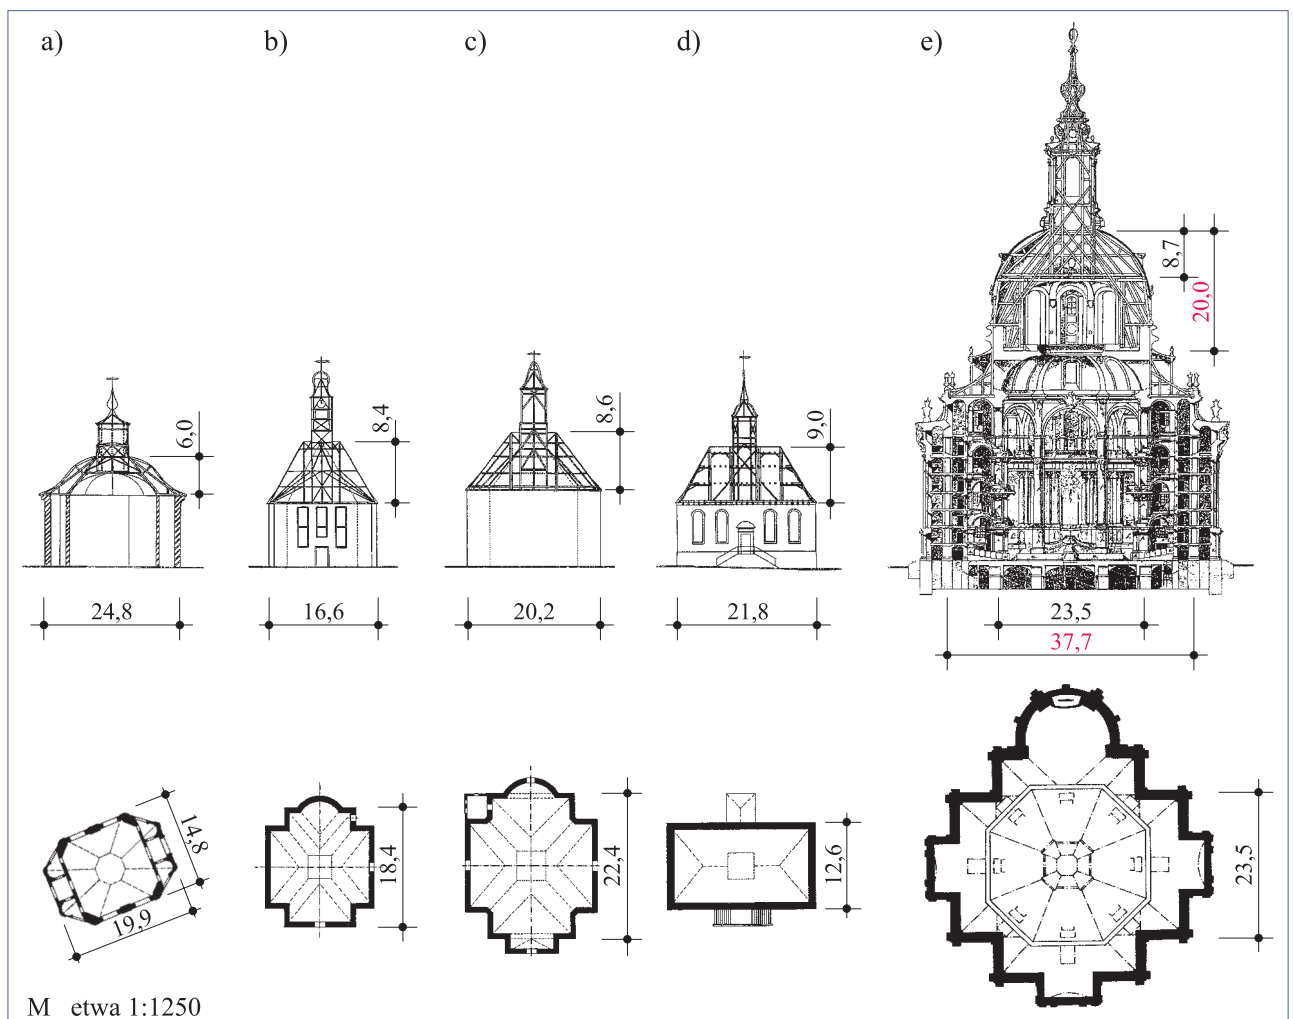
Vergleich der Spannweiten und der Bauhöhen der Strebwerke der vorab untersuchten Kirchbauten<sup>17</sup> mit dem Ersten Projekt der dresdner Frauenkirche.
